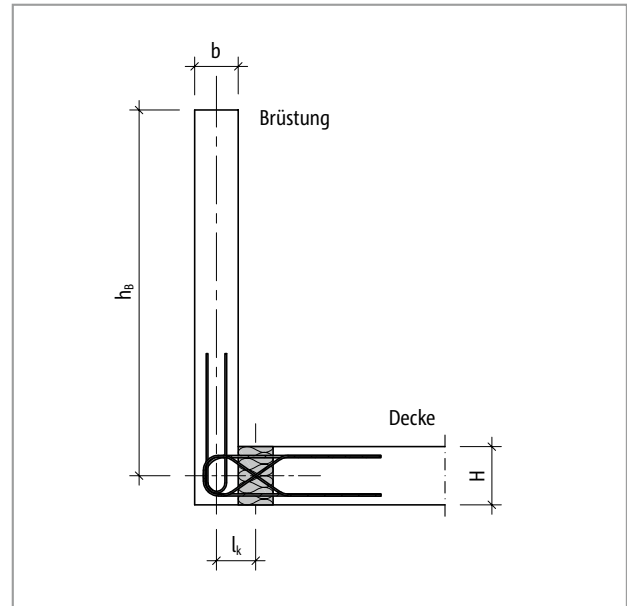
Schöck Isokorb® XT Typ F: Statisches System
